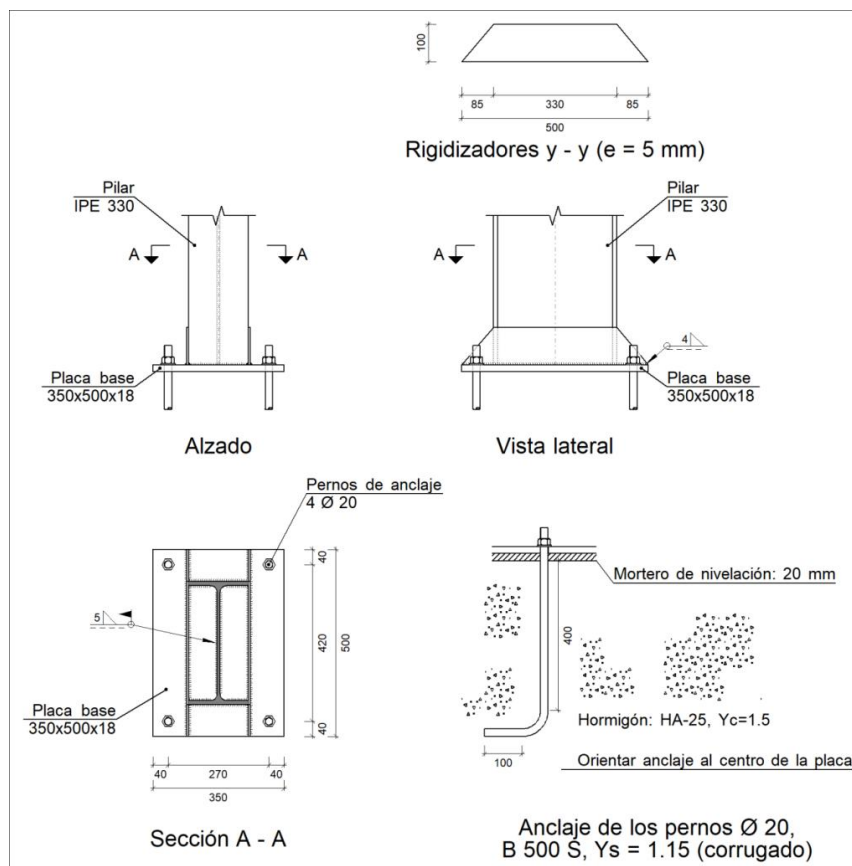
Placas de anclaje en el pórtico de fachada. Unión tipo 1
